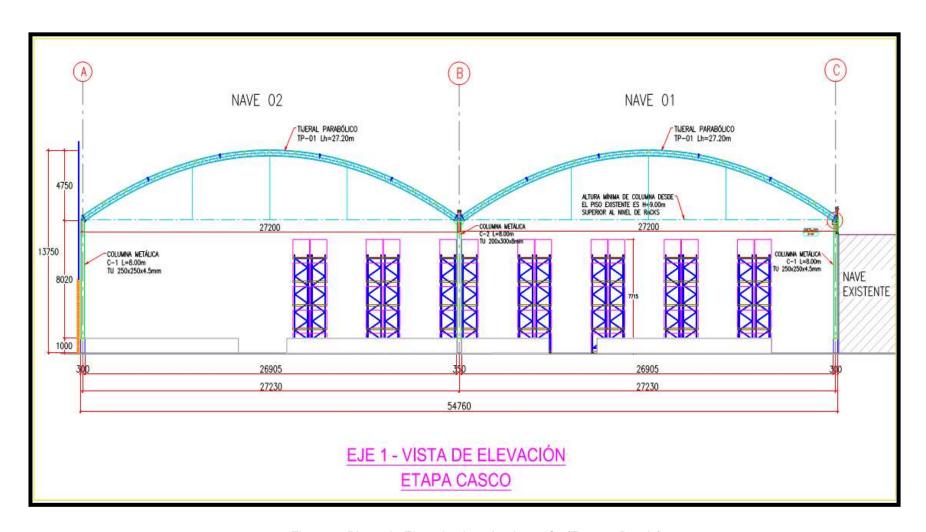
Plano de Eje 1 de vista de elevación (Fuente: Propia)
